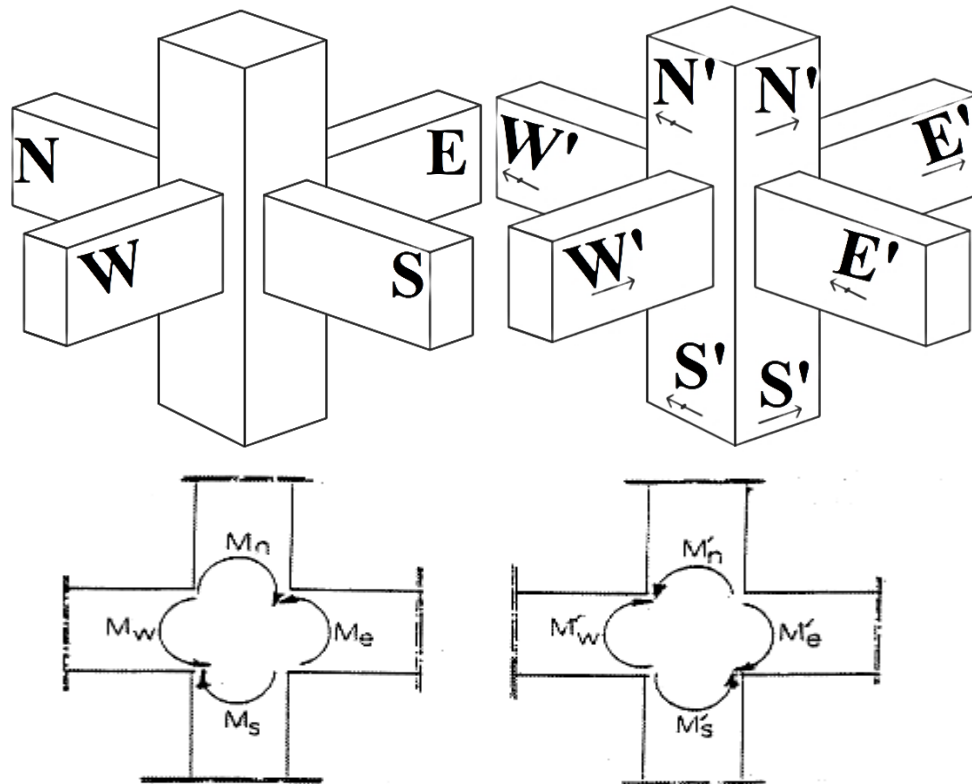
Dimensionnement des nœuds poteaux-poutres
